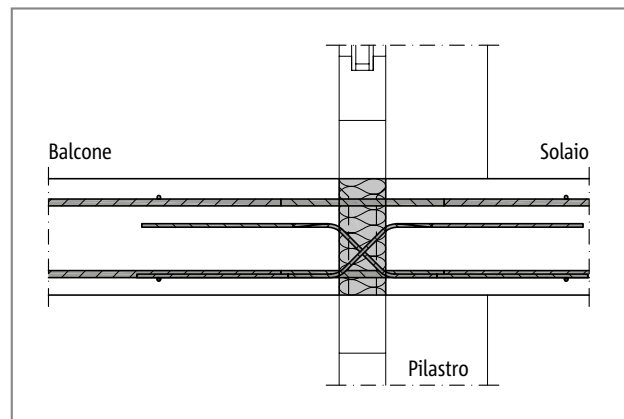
Schöck Isokorb® tipo D, sezione costruttiva per piastra bidirezionale
